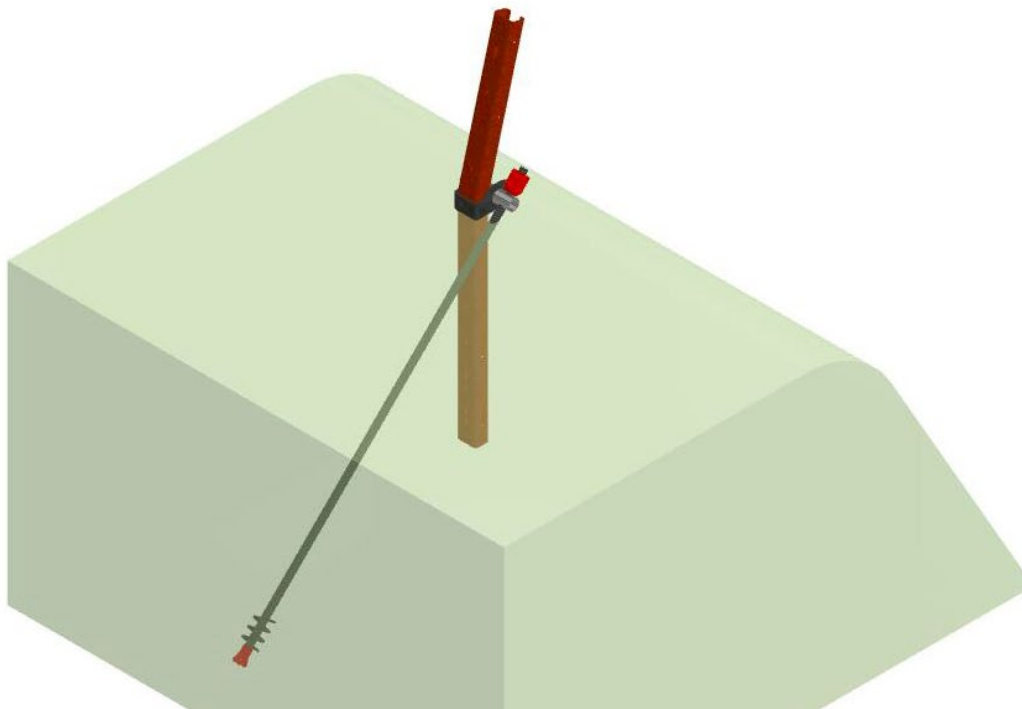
meccanismo di collasso con sistema ASDR-MRS installato
